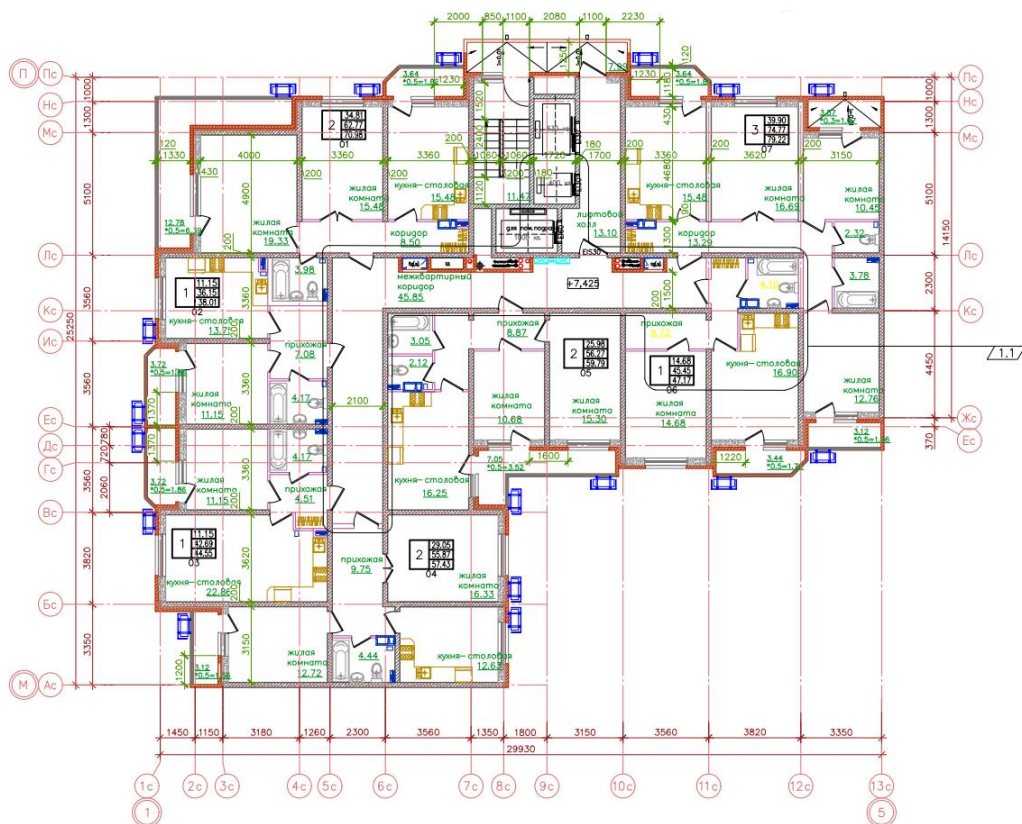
План 3 этажа БС-5 ЖК URAL
